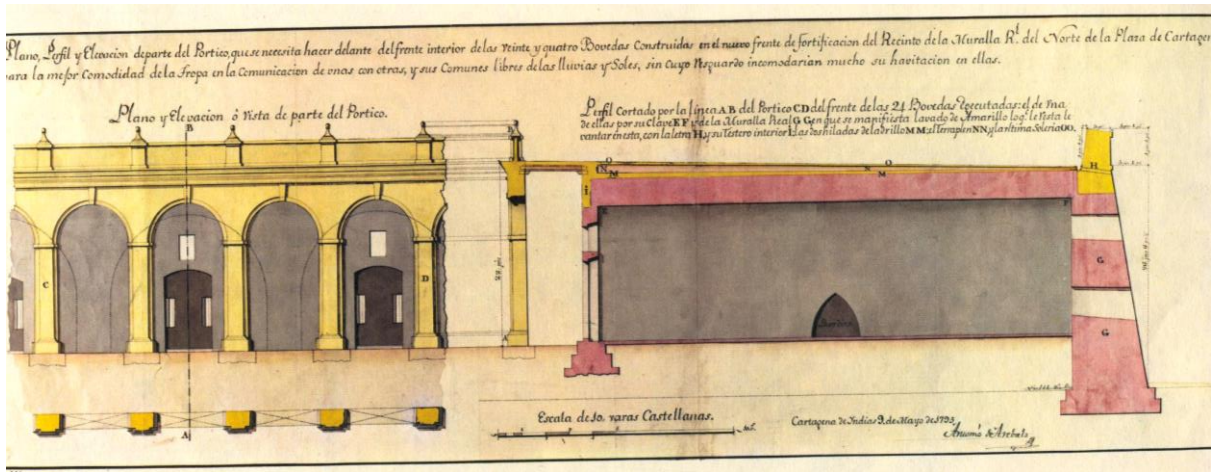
1795 Plano perfil y elevación de la parte del pórtico del recinto de la muralla¹⁰⁷
